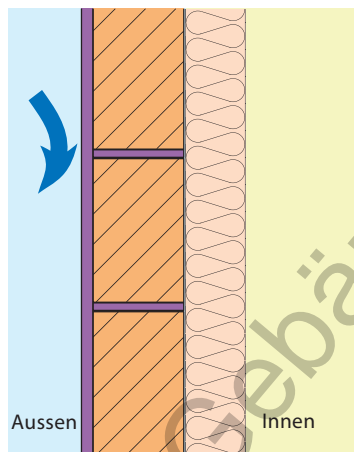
/302: Einschaliges Mauerwerk mit Aussenputz und Wärmedämmung innen
